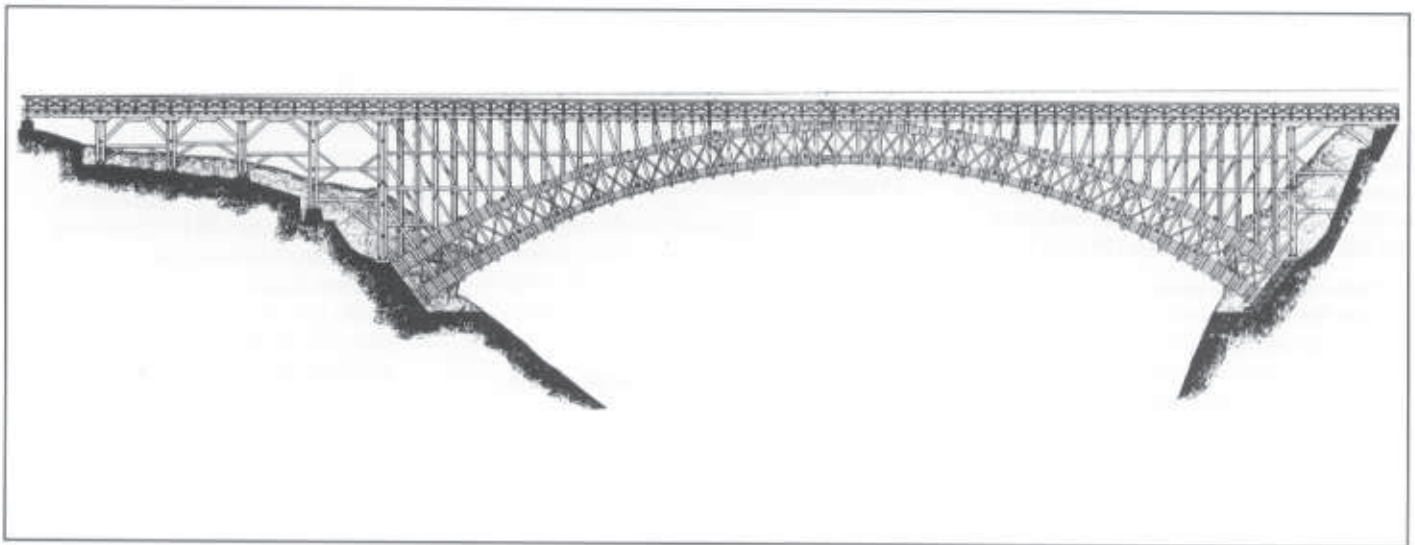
Cascade Bridge der Erie-Eisenbahn, USA um 1845 aus [1/4]
